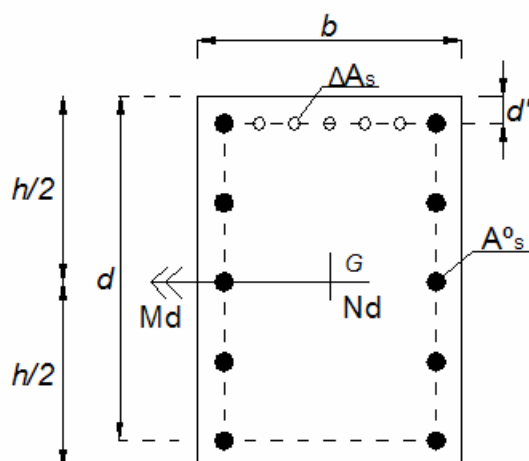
Seção retangular de concreto armado com armadura distribuída
